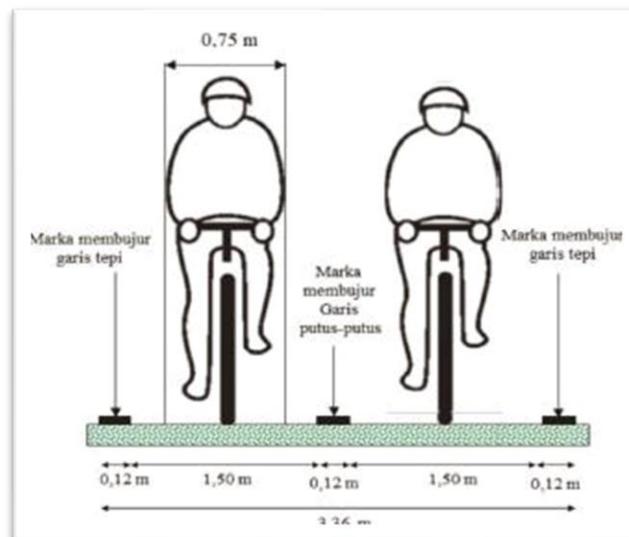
Lebar Minimum Dua Lajur Sepeda
